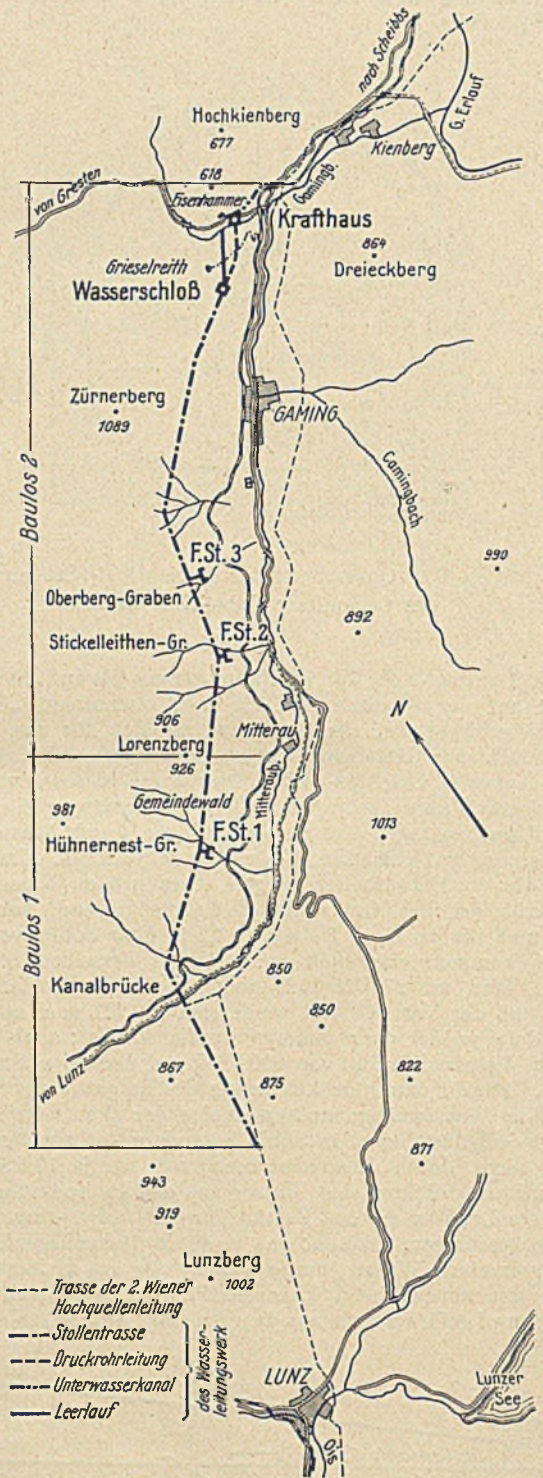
Lageplan Wasserleitungskraftwerk Kienberg—Gaming.
